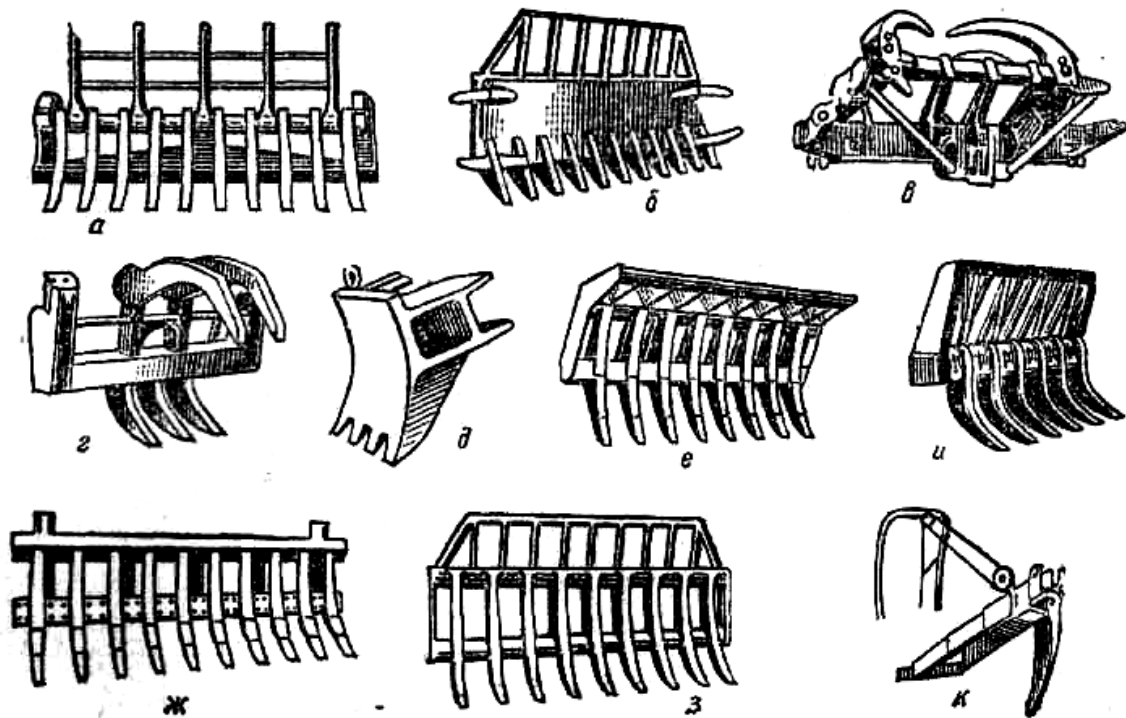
Типы отвалов корчевателей и корчевателей-сборителей:
